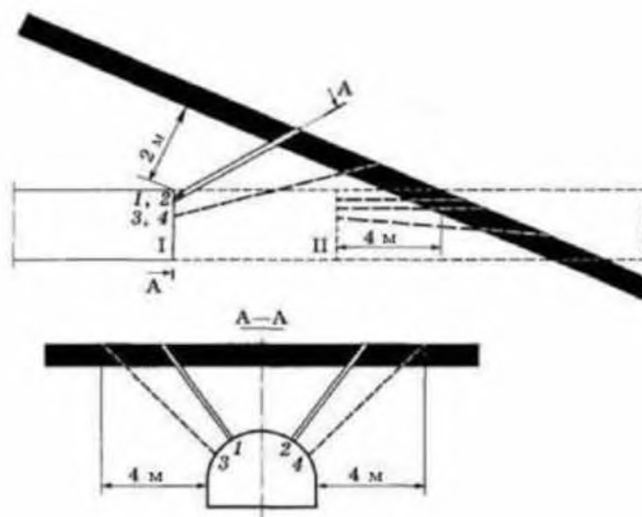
Схема расположения скважин для гидрорыхления угольного пласта при вскрытии угольного пласта пологого, наклонного и крутонаклонного залегания:
